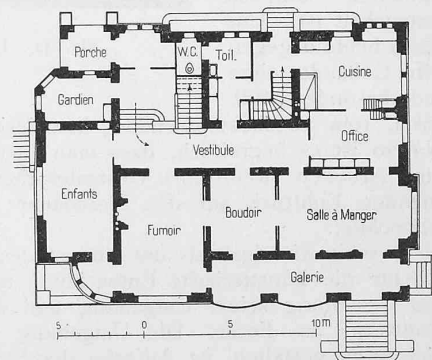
Plan du rez-de chaussée de la maison de M. J. J. Kohler. — Echelle 1 : 400.
